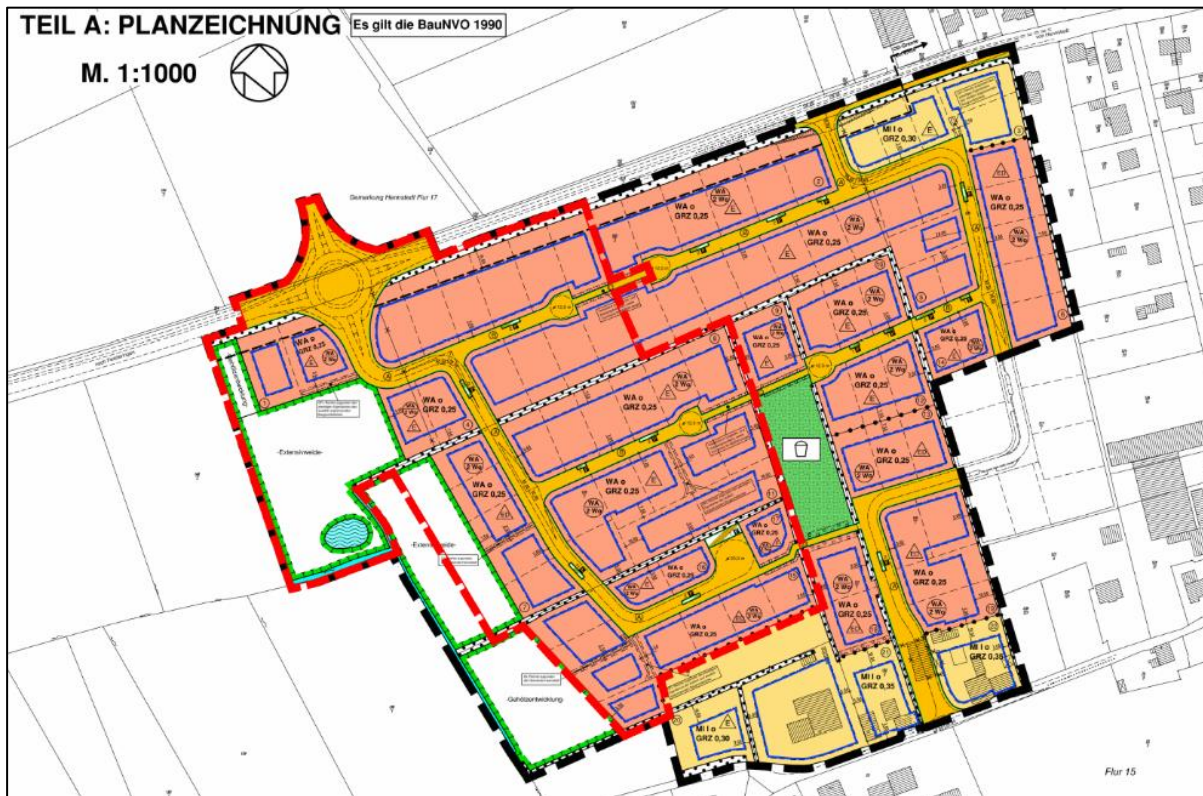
Planbild des rechtskräftigen Bebauungsplans Hennstedt 12, in rot eingezeichnet ist der Bereich der Teilauhebung, ohne Maßstab
